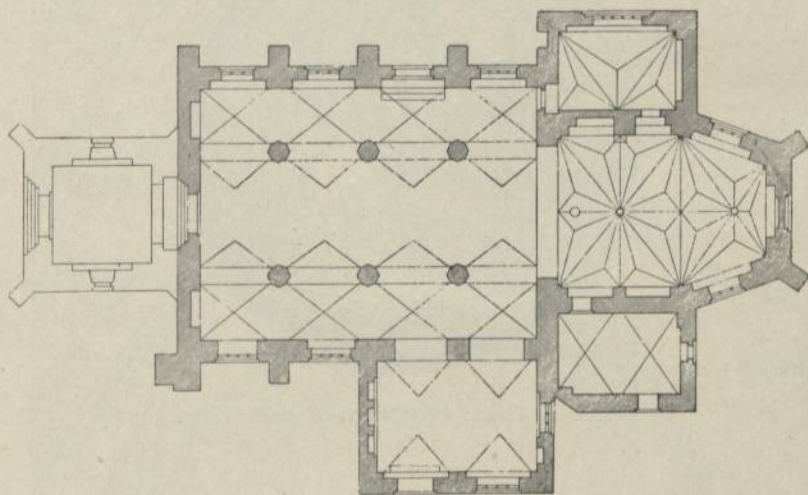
Daber; Pfarrkirche, Grundriß. 1:400.
